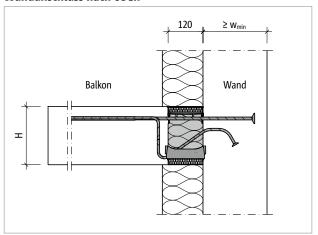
Schöck Isokorb® XT Typ K-U: Wandanschluss nach oben bei Außendämmung
